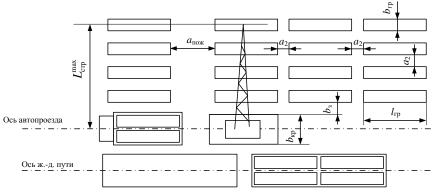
Расчетная схема для определения параметров открытого склада для тяжеловесных грузов с использованием стрелового автомобильного крана по методу элементарных площадок
